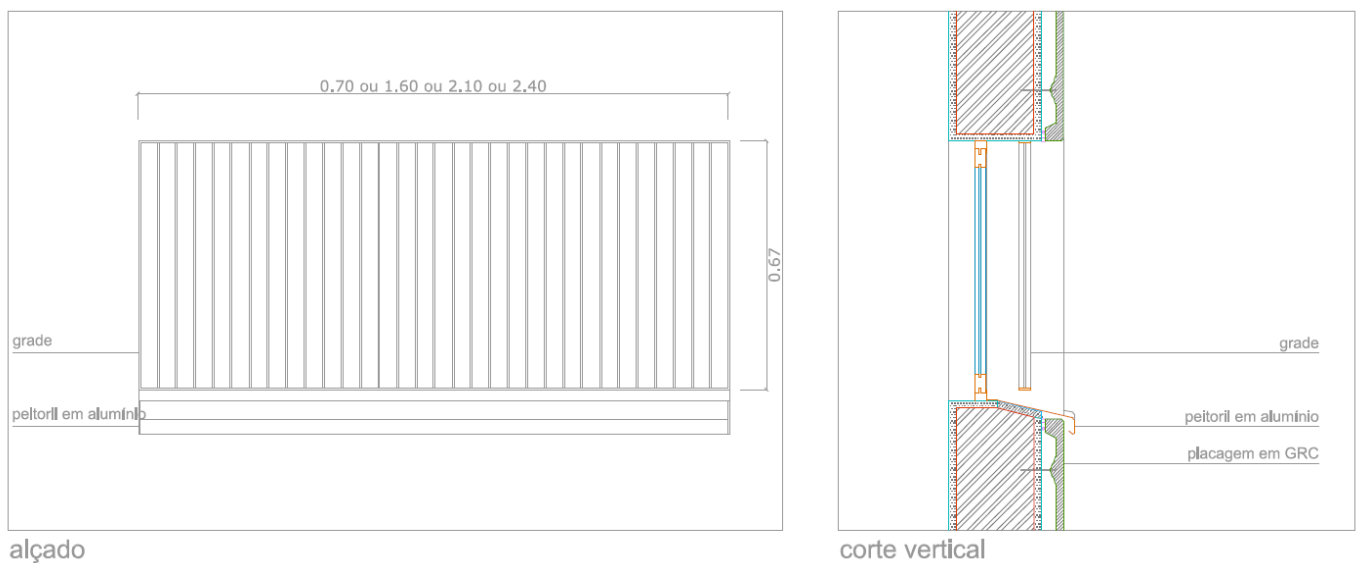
Novo gradeamento. Alçado e perfil (escala 1/20).
